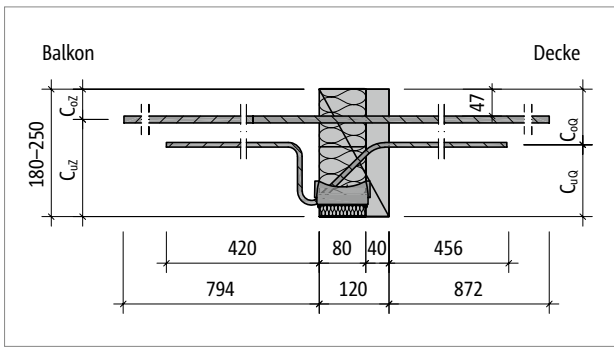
Schöck Isokorb® RT Typ K-M1: Produktschnitt
